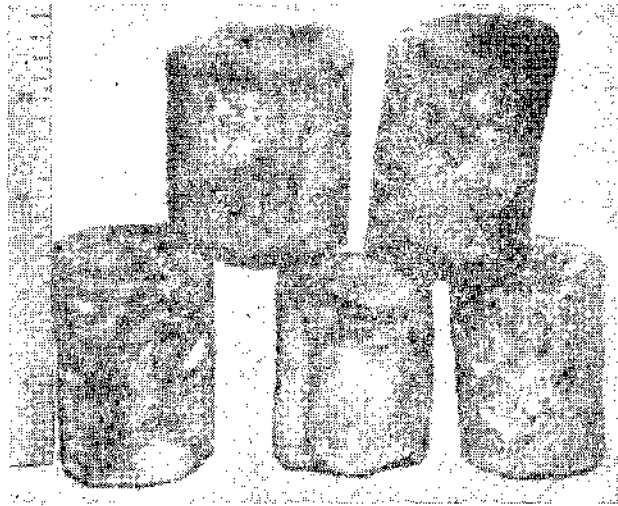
Бетонные керны, применяемые для испытания на сжатие.
